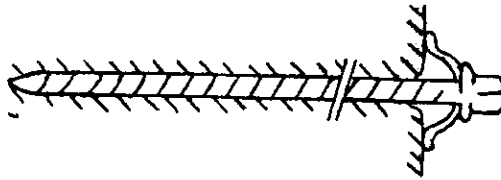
Anclaje por medio de barra nervurada hincada en el terreno.
